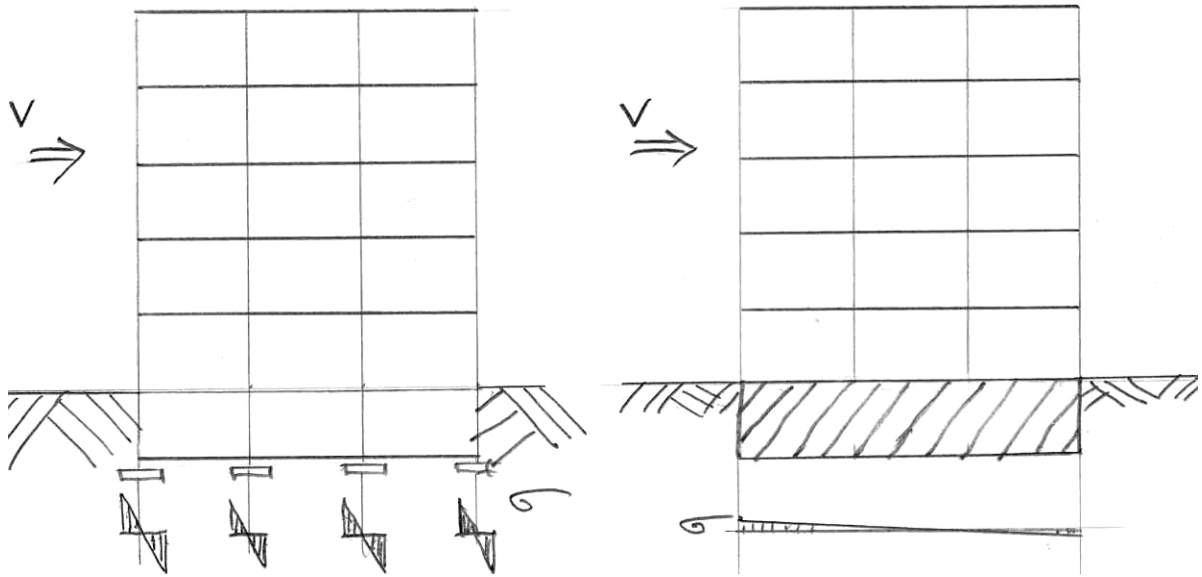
Un radier général raidi par les murs de sous-sol base réduit les contraintes à la fondation.
